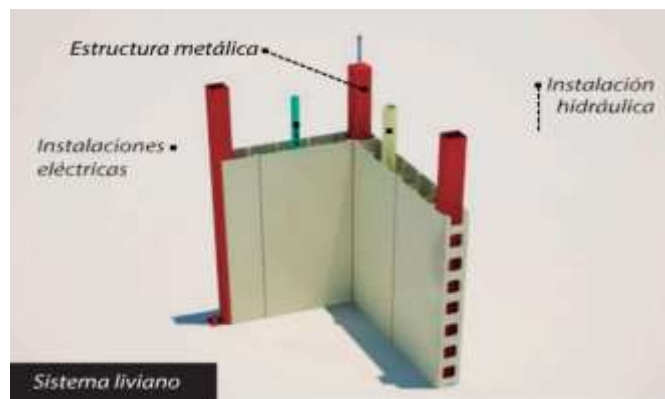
Detalles del sistema liviano con las instalaciones eléctricas, sanitarias y estructura metálica del concreto en paredes. Fuente: <https://azembla.com.co/es/>
